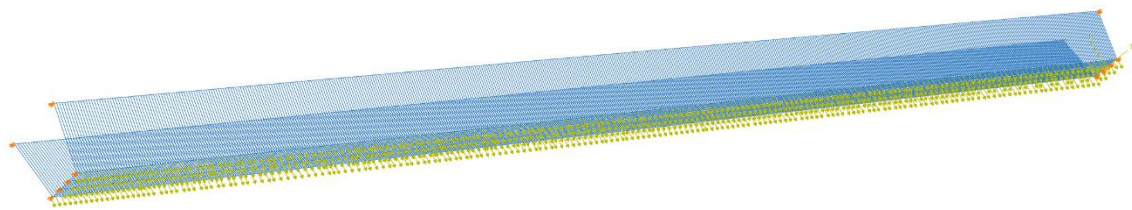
Cargas puntuales aplicadas sobre la base del puente.
